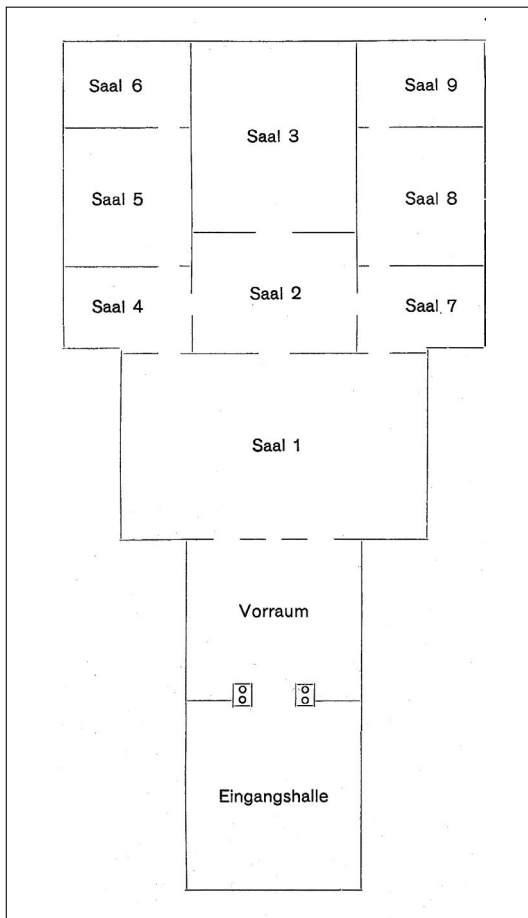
Grundriß der Ausstellungsräume, 1908.
